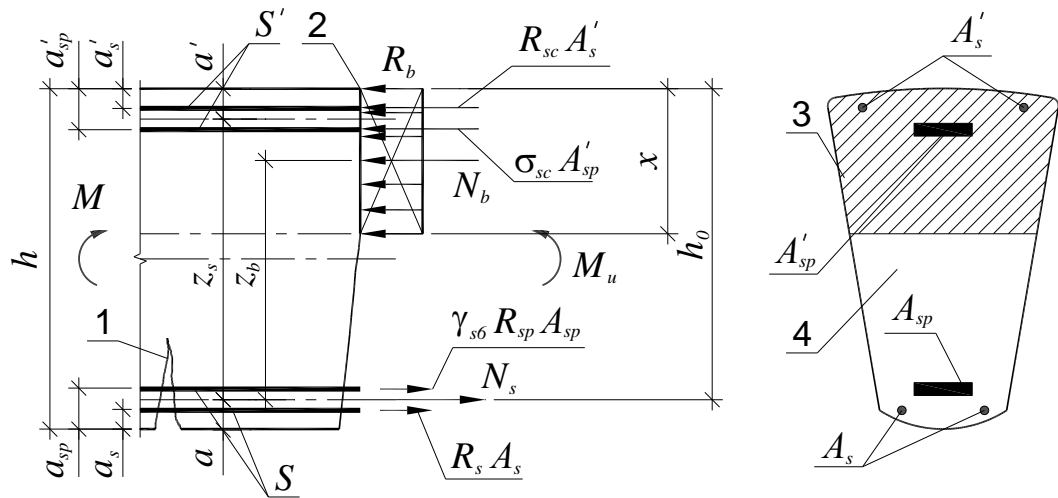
Схема усилий и напряжений в нормальном расчетном сечении элемента любой симметричной формы: 1 – нормальные трещины; 2 – расчетное сечение; 3 – сжатая зона сечения; 4 – то же, растянутая арматура;
